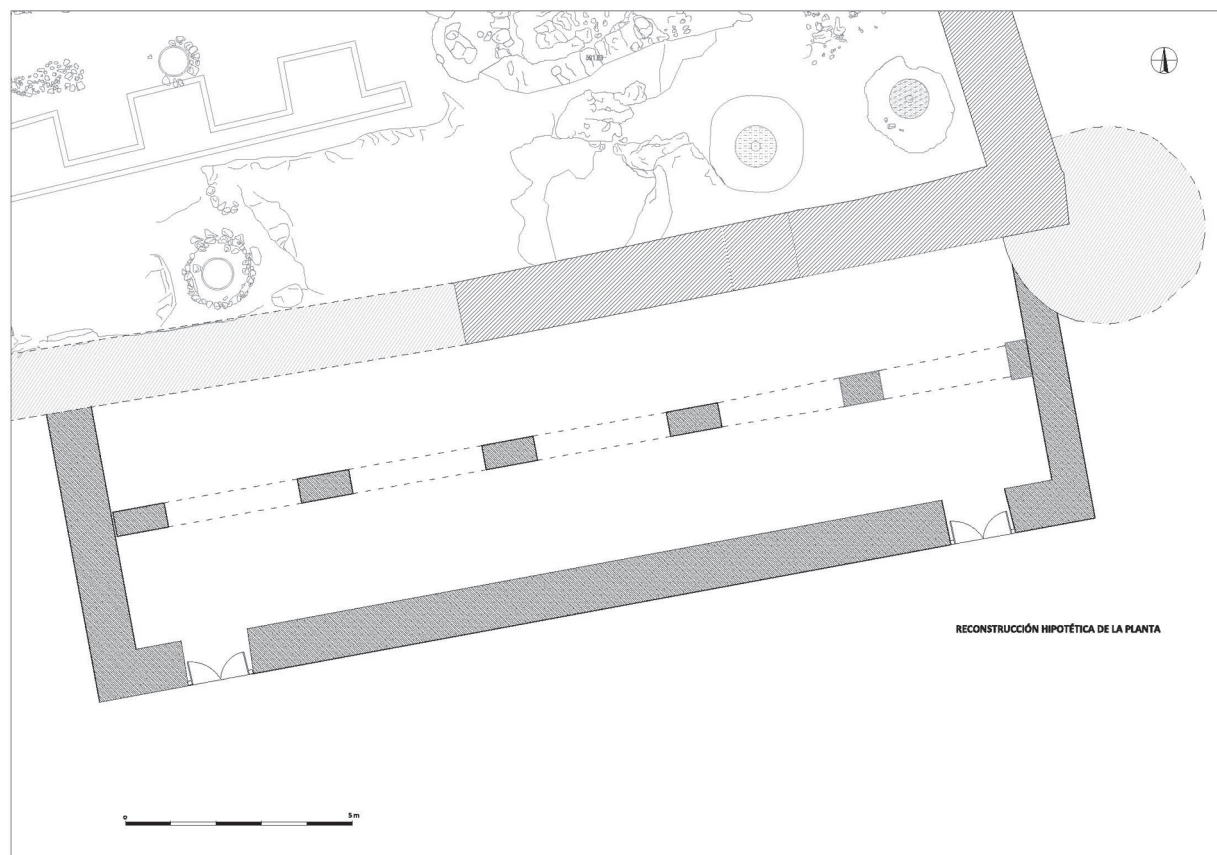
Detalle de la reconstrucción hipotética de la planta del pósito en 1710.
